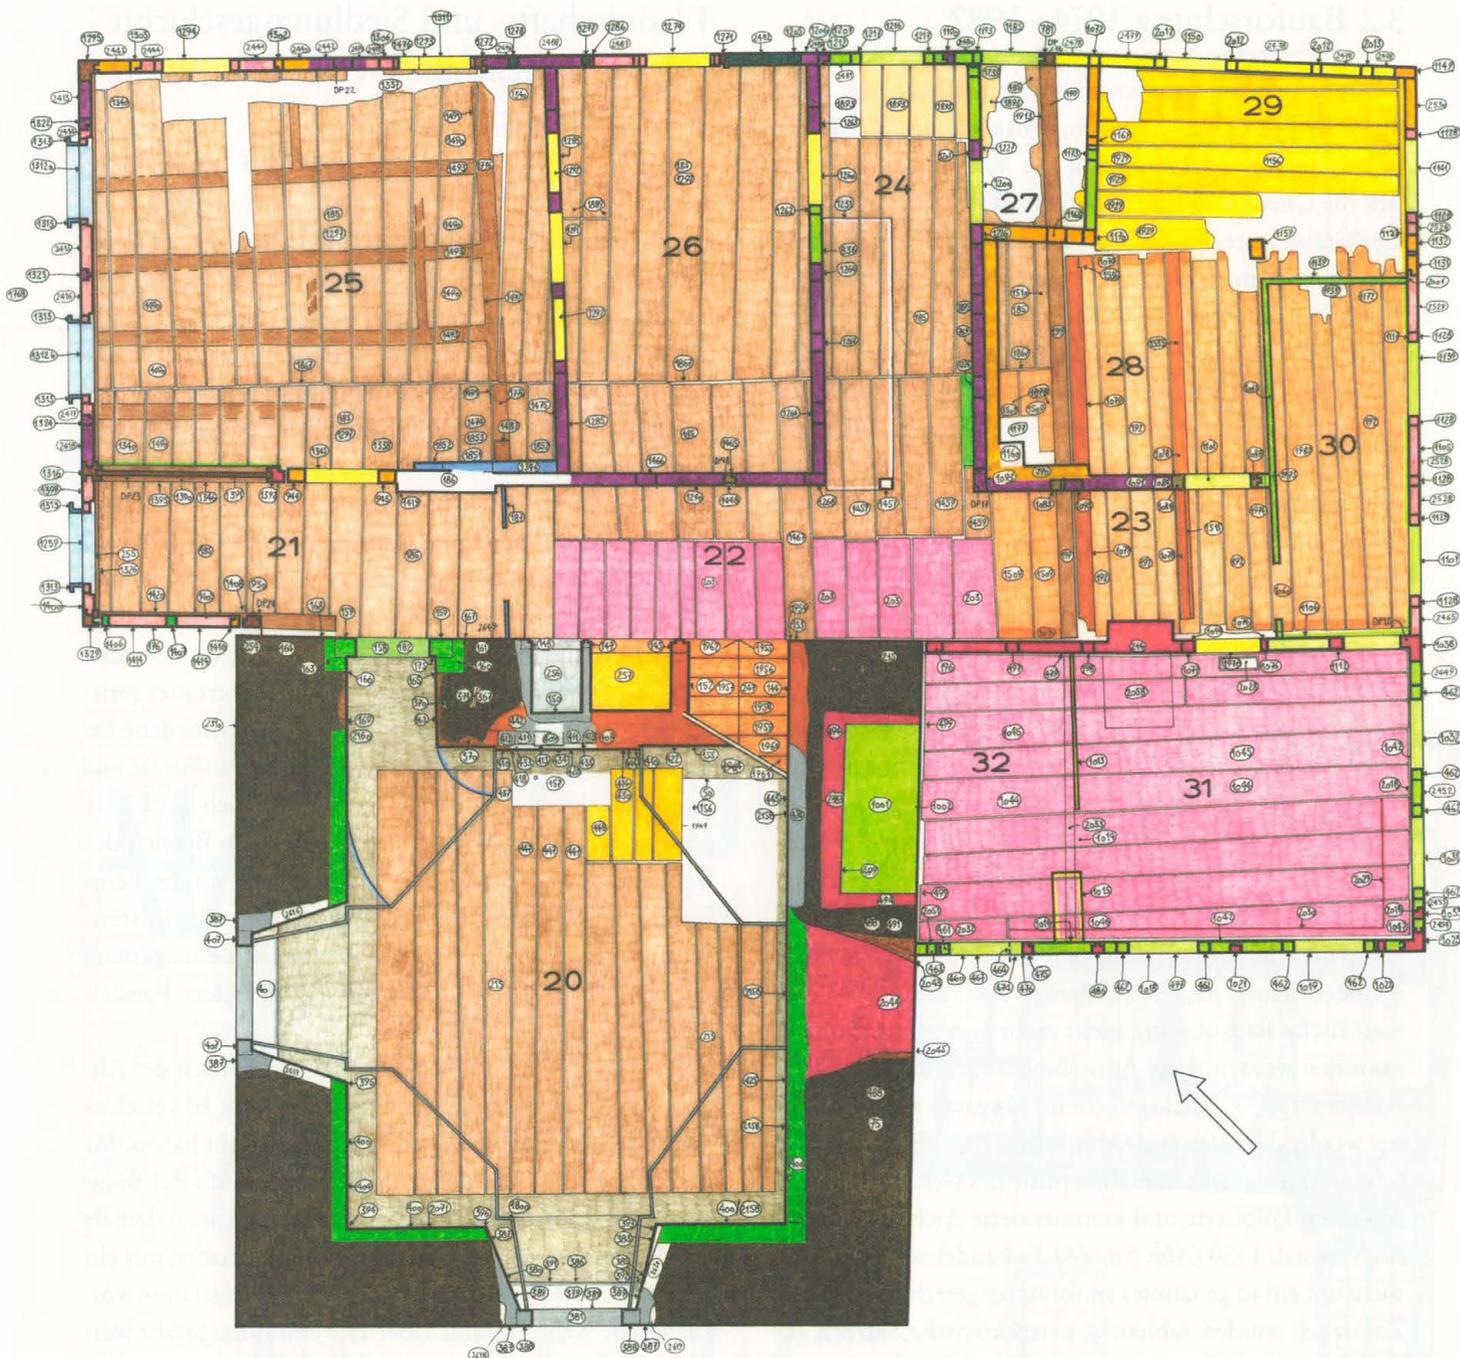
Burg Zug 1778–1782. Grundriss 2. Obergeschoss. Aufnahmeplan von 1970 (Originalmassstab 1:50) mit eingezeichneten Baubefunden. Reproduktionsmassstab 1:100.
